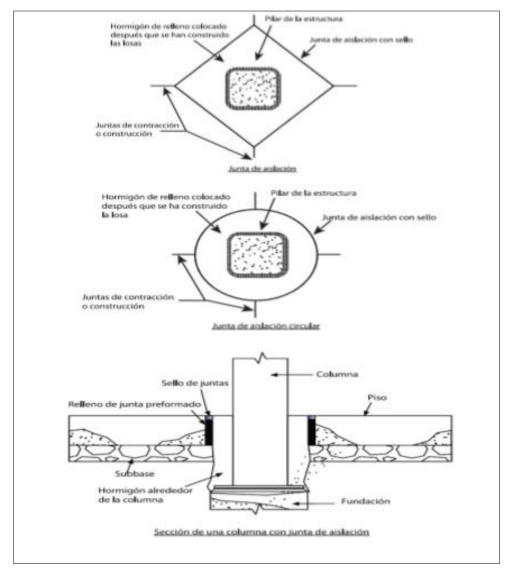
Juntas de aislamiento en muros y pilares (ACI 360R-10)
